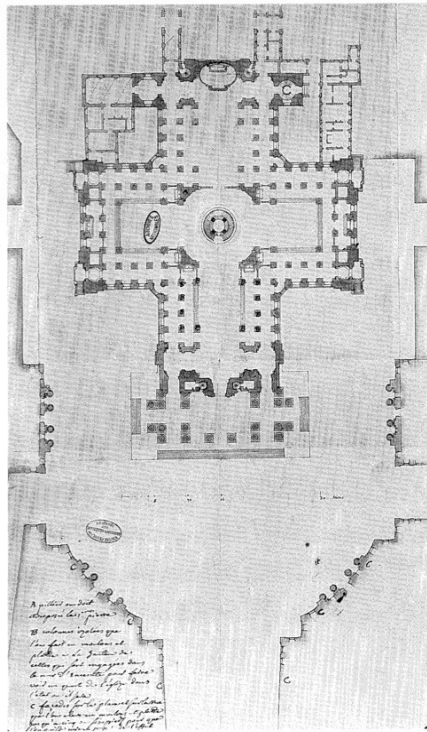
Pianta allungata sull'ingresso e il coro.
